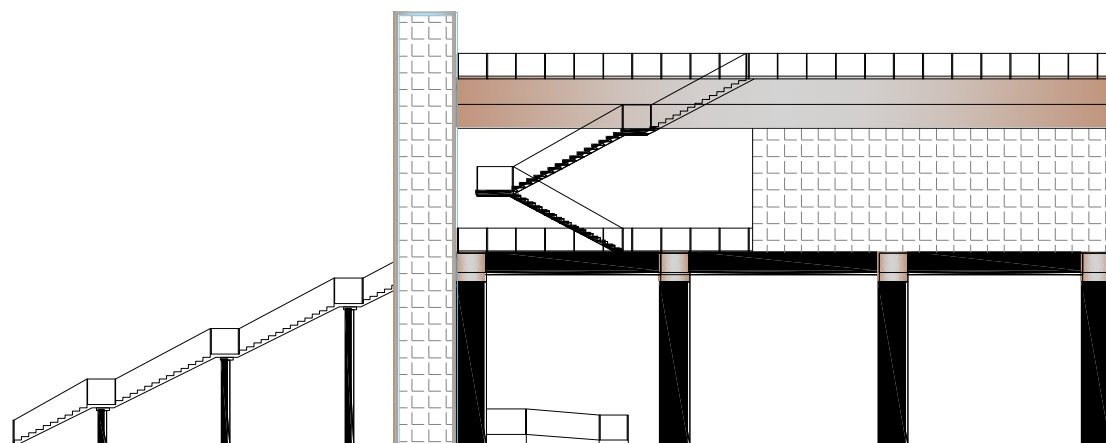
岛式车站（线间距 6.6m）立面图
